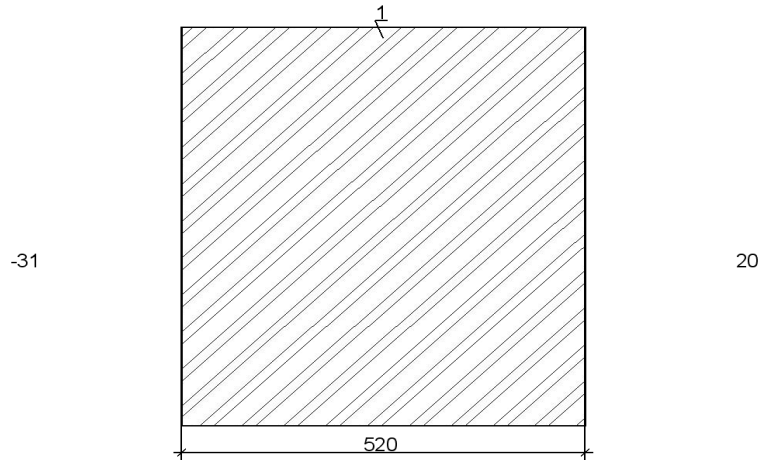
Конструкция наружной стены до тепловой изоляции
